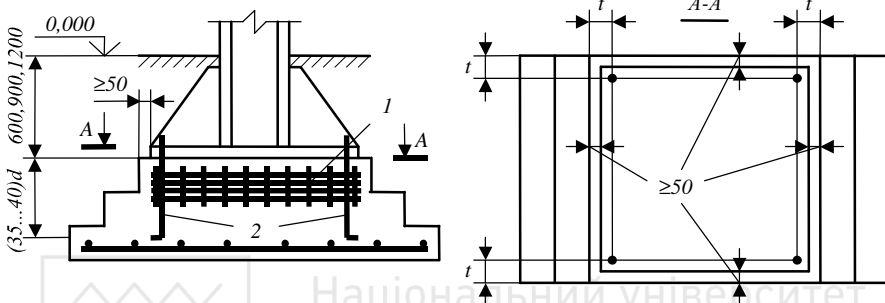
Монолітний залізобетонний фундамент під сталеву колону:
